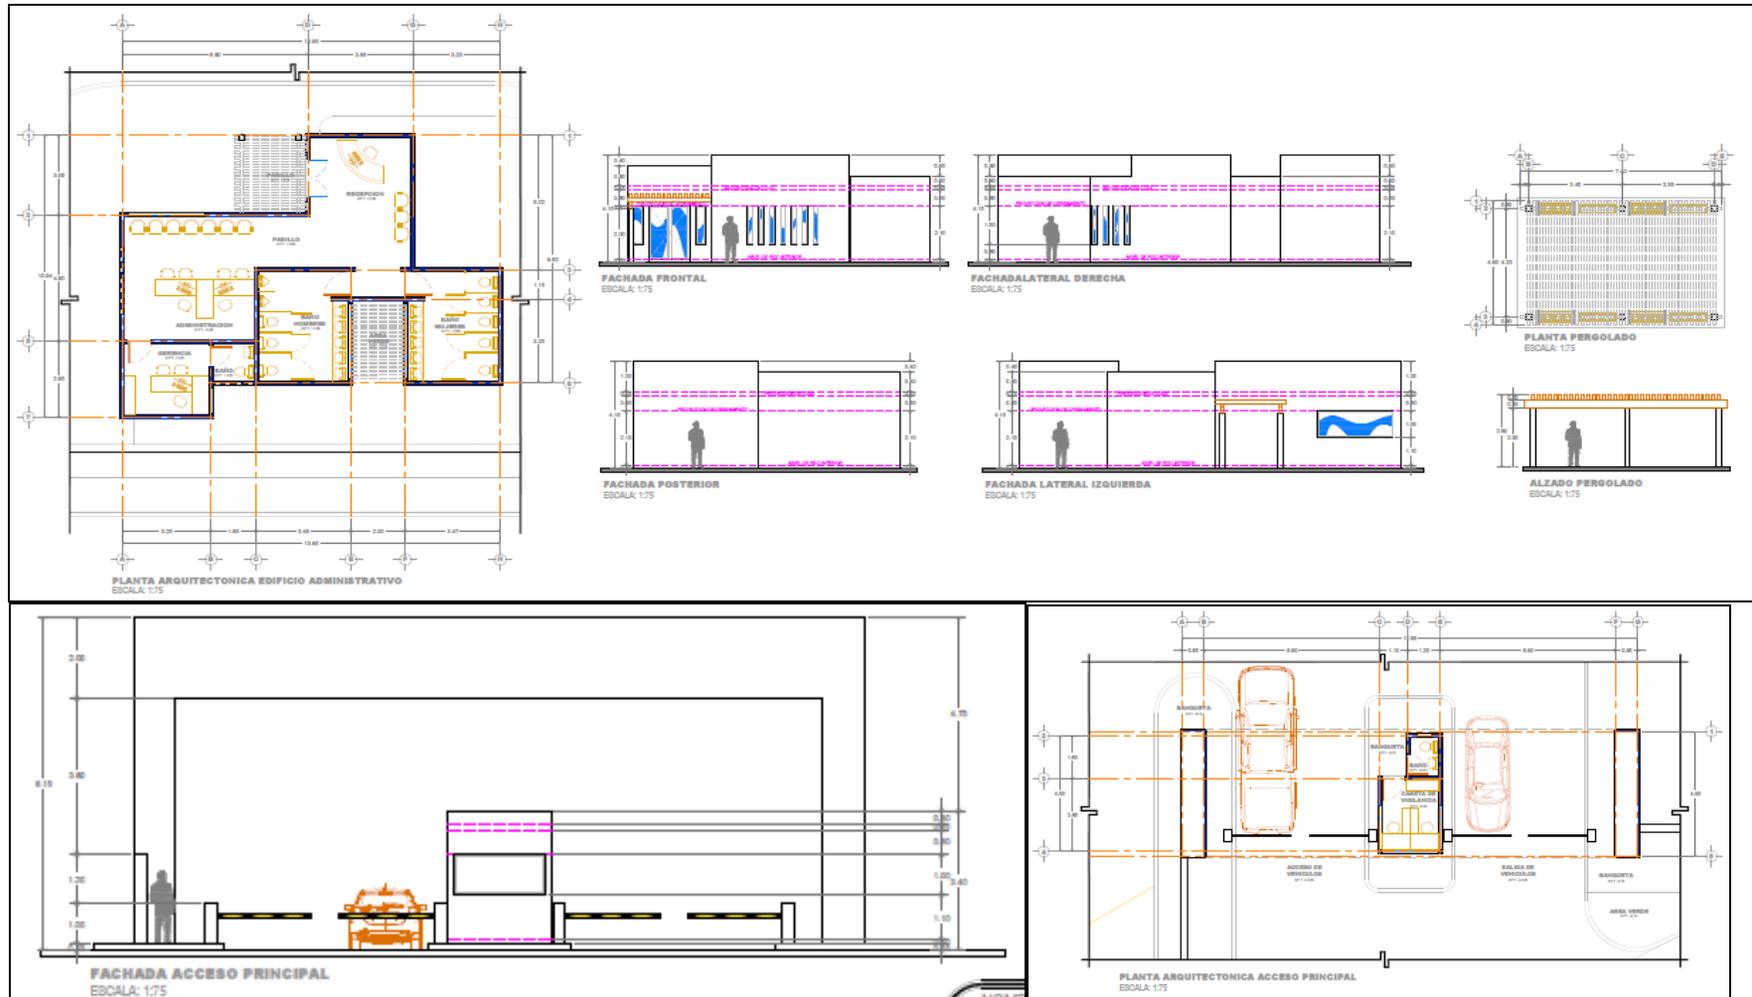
Plano arquitectónico de detalles (área administrativa y acceso). Ver detalles en Plano A-02.
